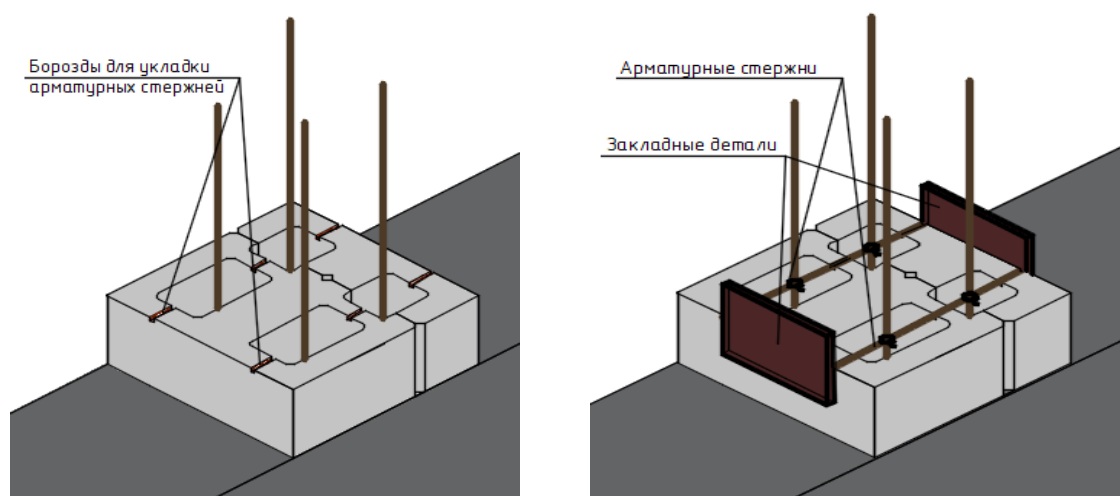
Монтаж закладной детали: устройство борозд для горизонтальной укладки арматурных стержней с пластинами для крепления к вертикальным арматурным стержням
